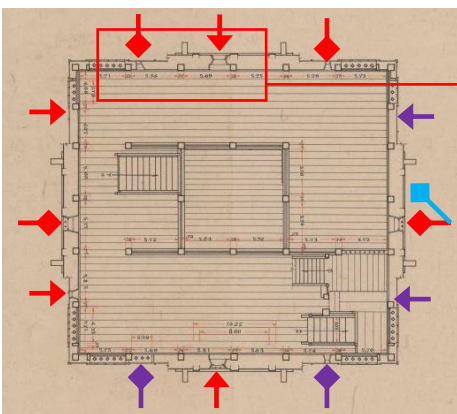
4階平面図 (部分) 姫路市立城郭研究所蔵
